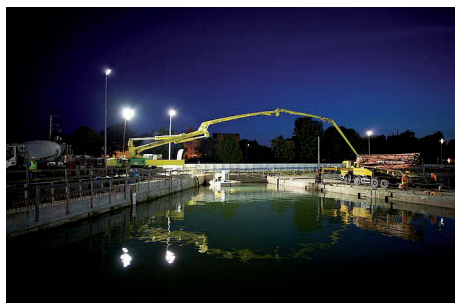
Dober do betonowania podwodnego [zdjęcie autora]
